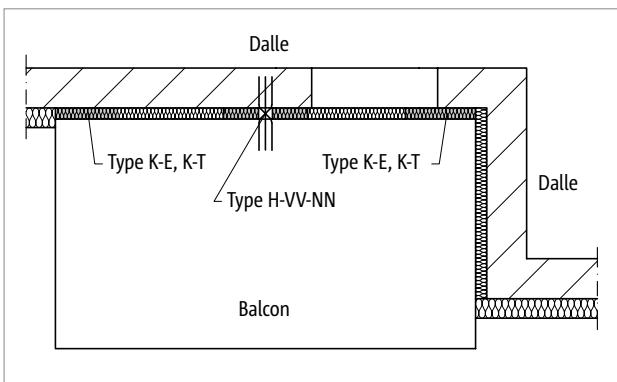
Schöck Isokorb® T Type H : Balcon en porte-à-faux
